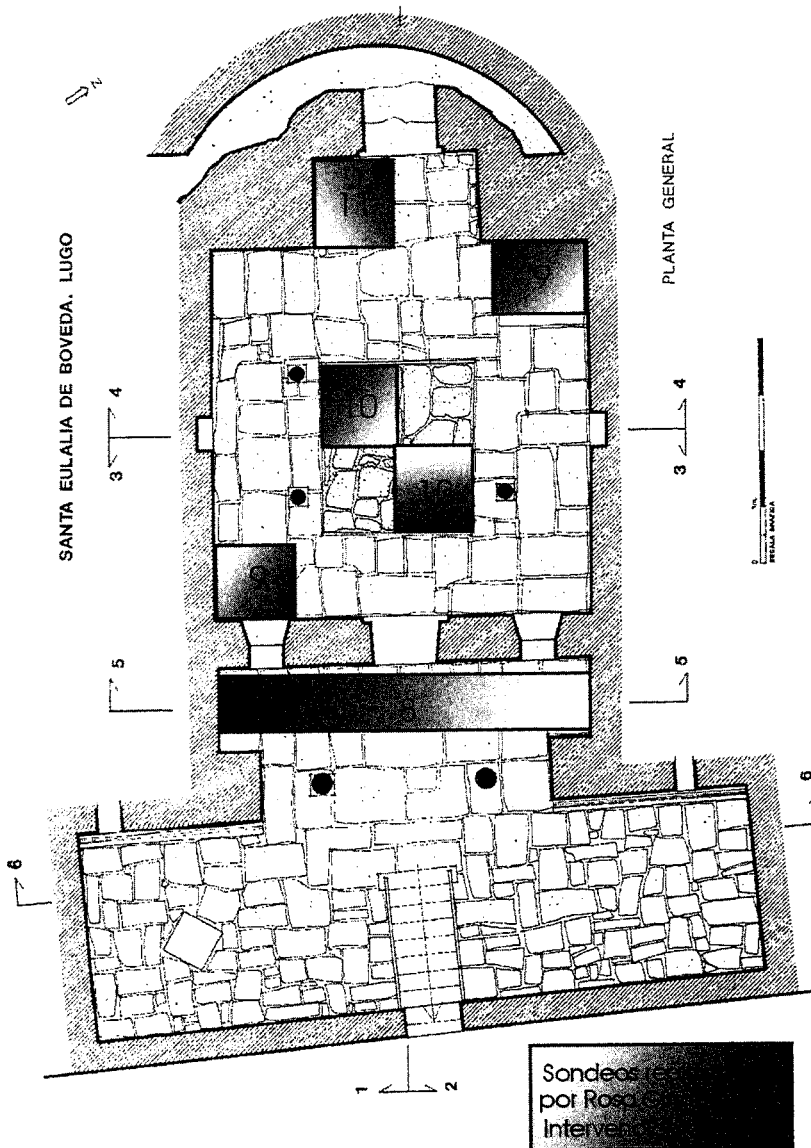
Planta del edificio de Santa Eulalia de Bóveda en la que se observan los sondeos realizados por Rosa Gimeno durante la campaña de intervención de 1989, copiados de una planimetría inédita que forma parte de la citada memoria de excavación depositada en la Dirección Xeral de Patrimonio. Los restos de canalizaciones romanas fueron localizados en los sondeos 10, 11 y 8.
